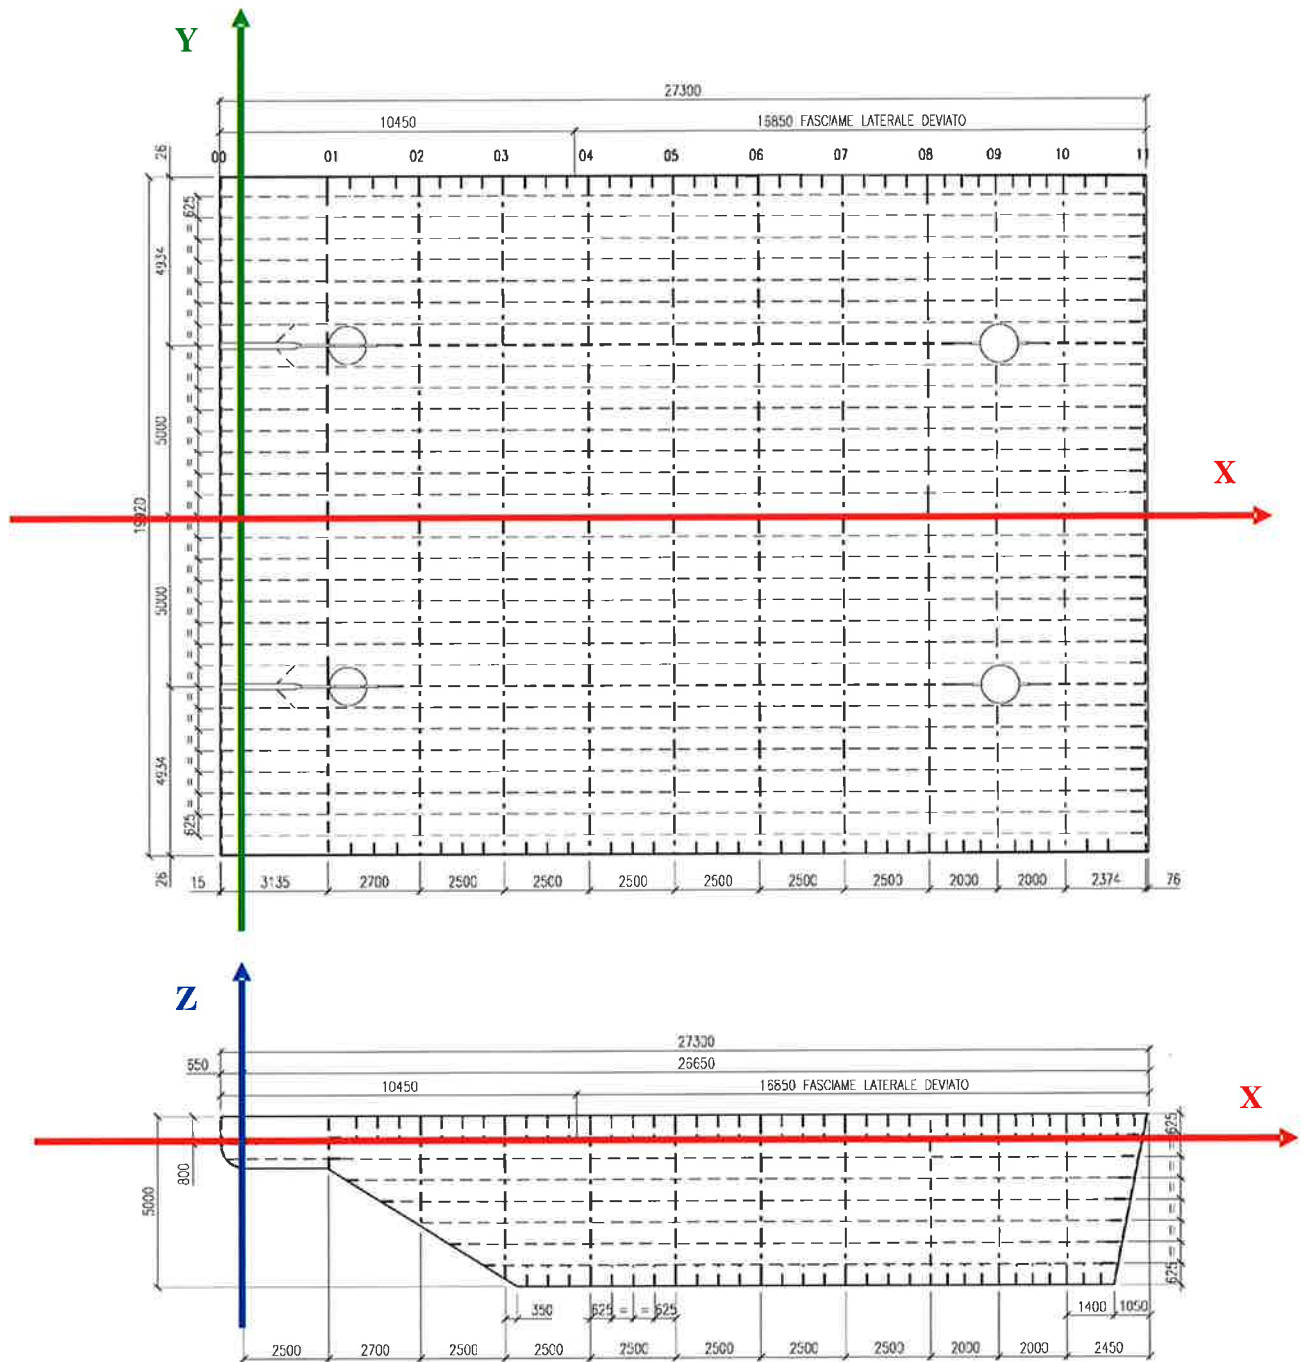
POSIZIONE SISTEMA DI RIFERIMENTO GLOBALE DEL MODELLO IN PIANTA E ALZATO
